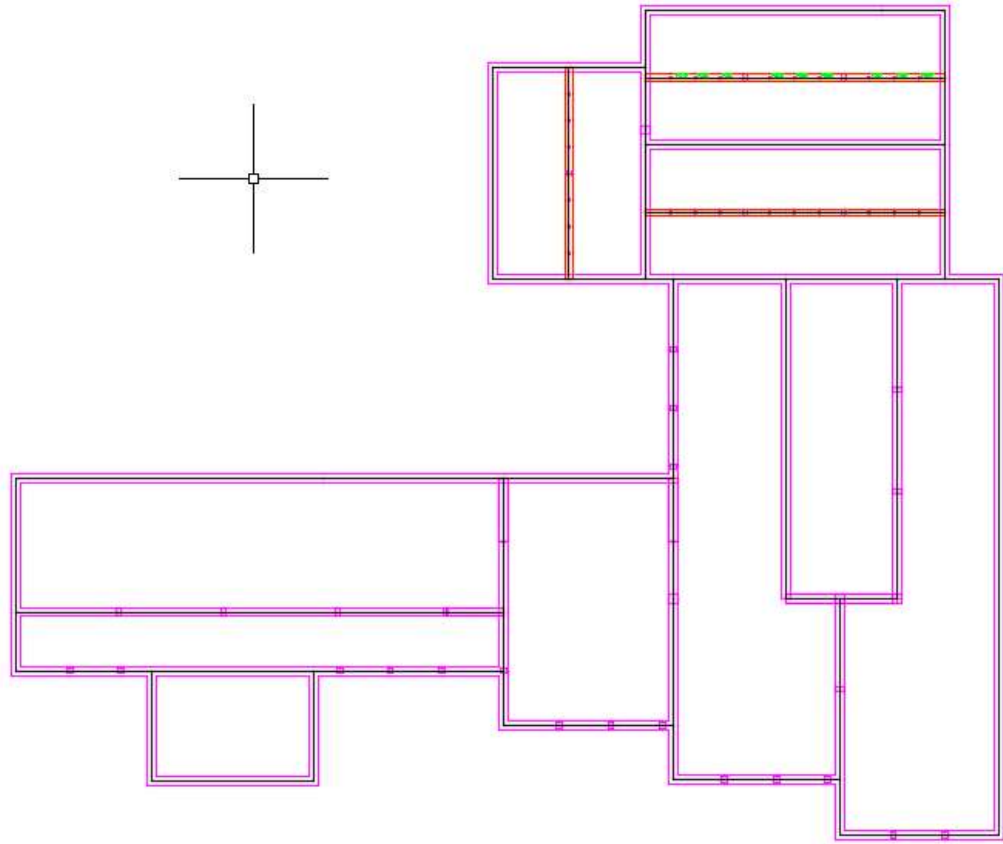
Posizionamento dei tre telai in acciaio al piano seminterrato
